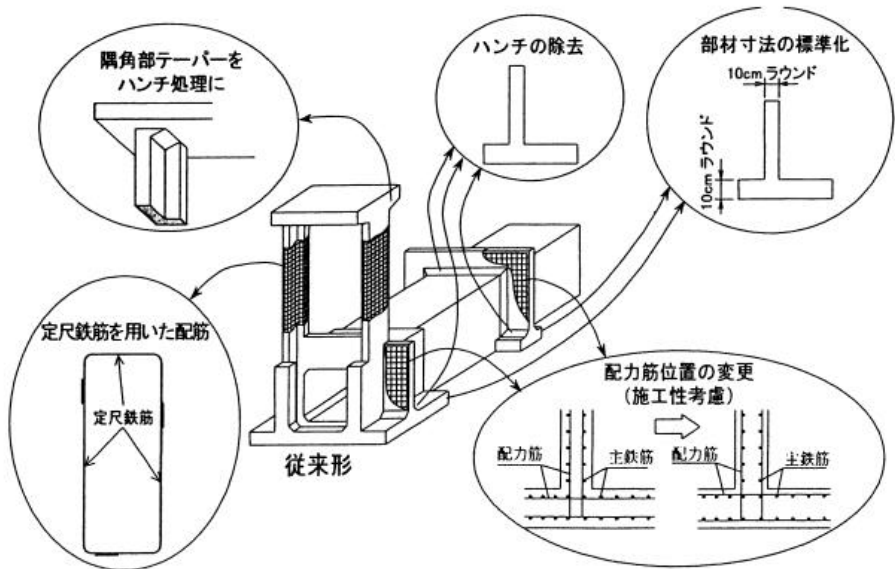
樋門の設計・施工合理化策の概要図（胸壁・しゃ水壁、門柱）
